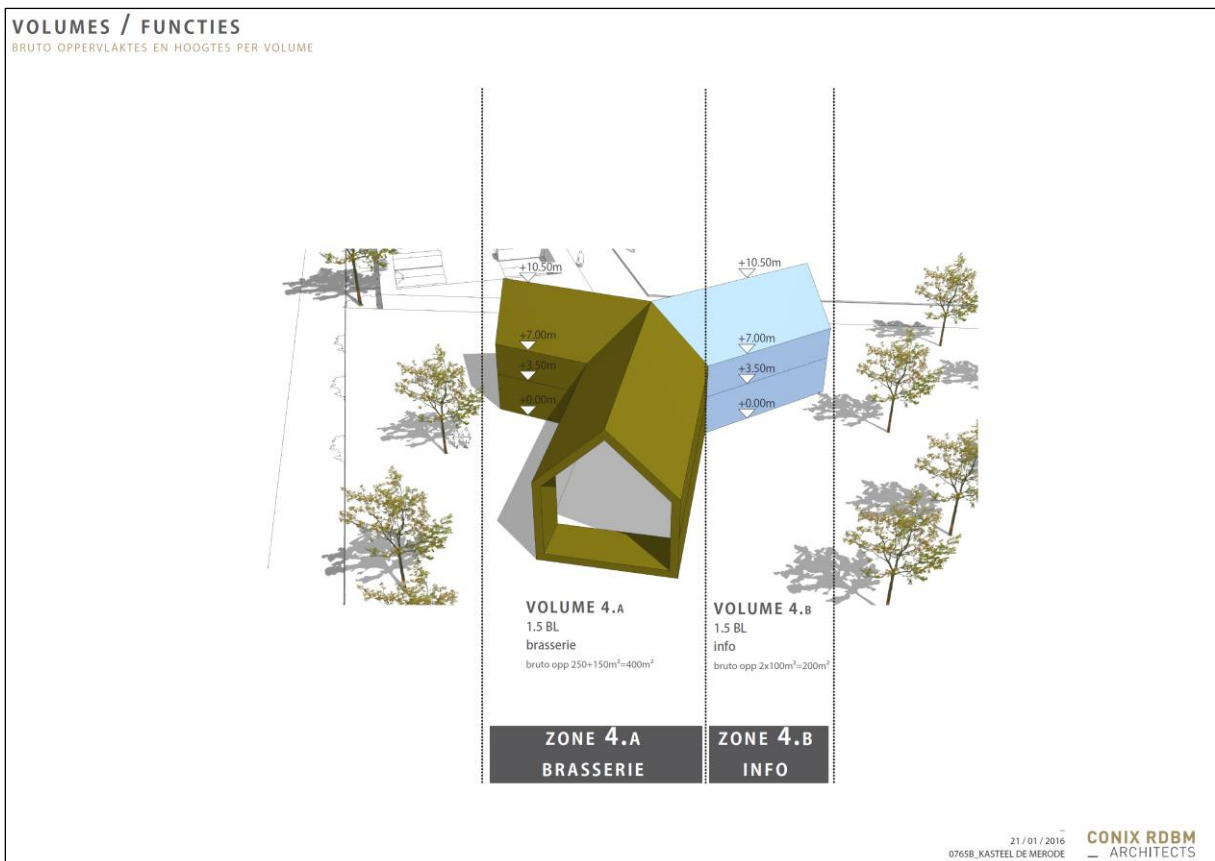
Overzichtsbeeld geplande ontwikkeling (uit: Masterplan Kasteelpark de Merode)
